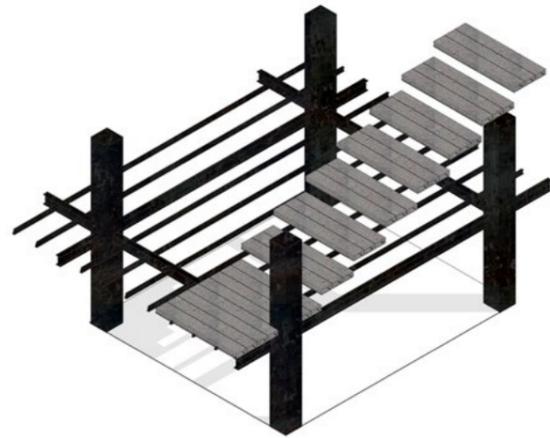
Construcción en seco | Montaje de losas prefabricadas
